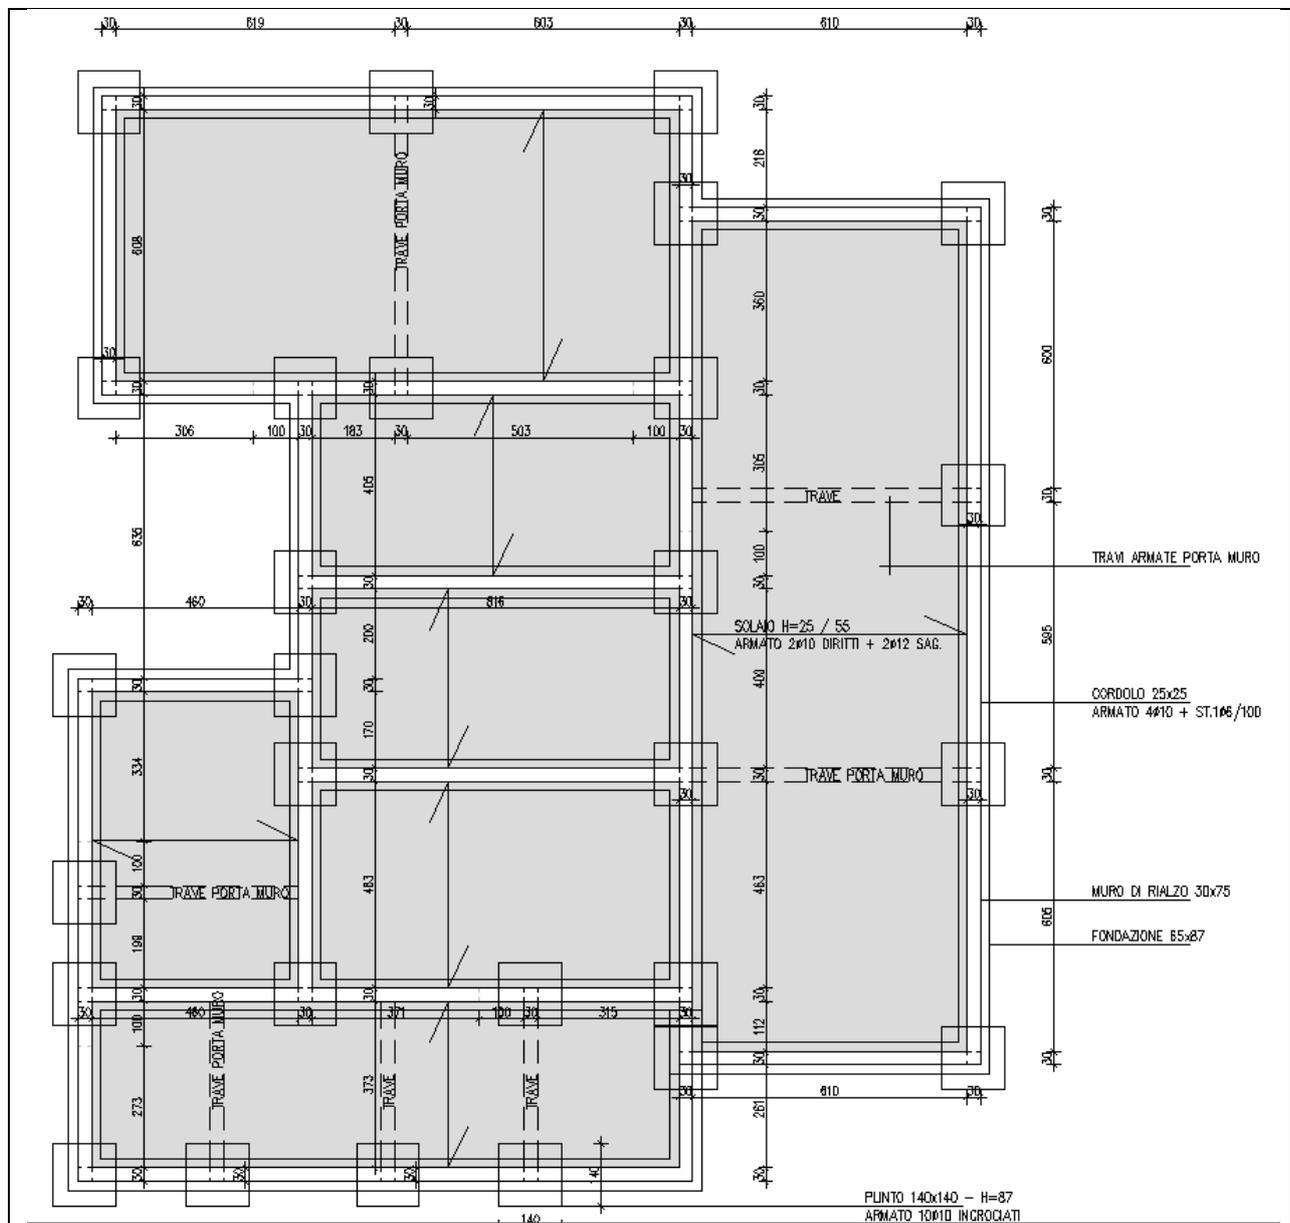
Planimetria delle fondazioni e dei solaio portato del piano rialzato
